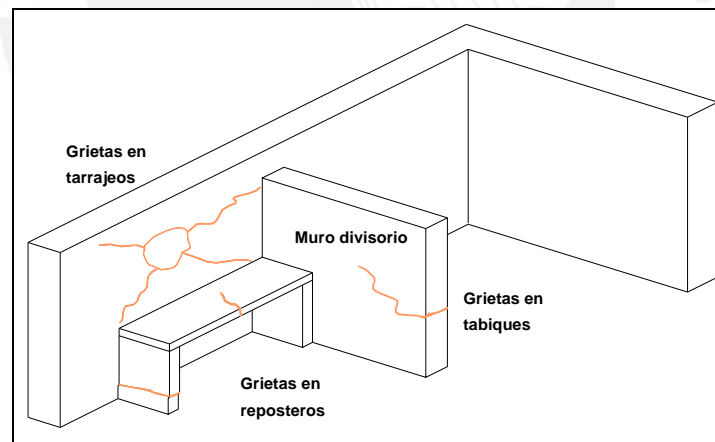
Grietas no estructurales (Asociación Colombiana de Ingeniería Sísmica 2002)
